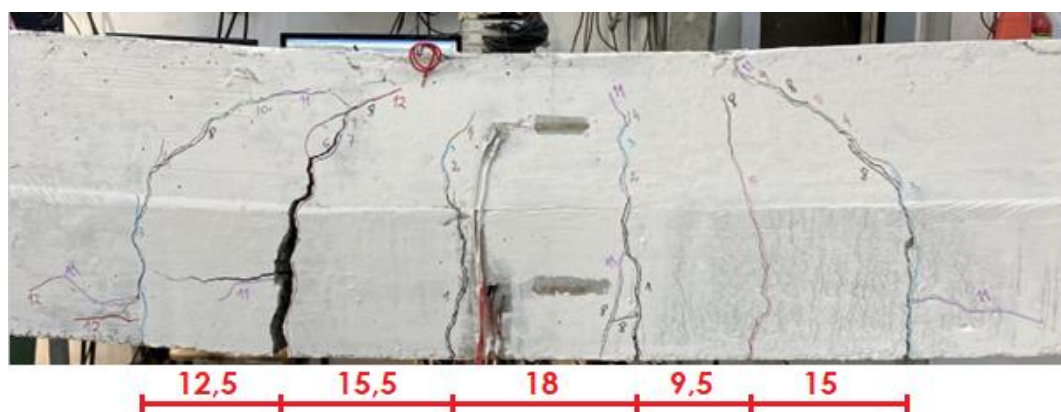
Espaçamento entre fissuras na viga 2 (espaçamento em centímetros)
